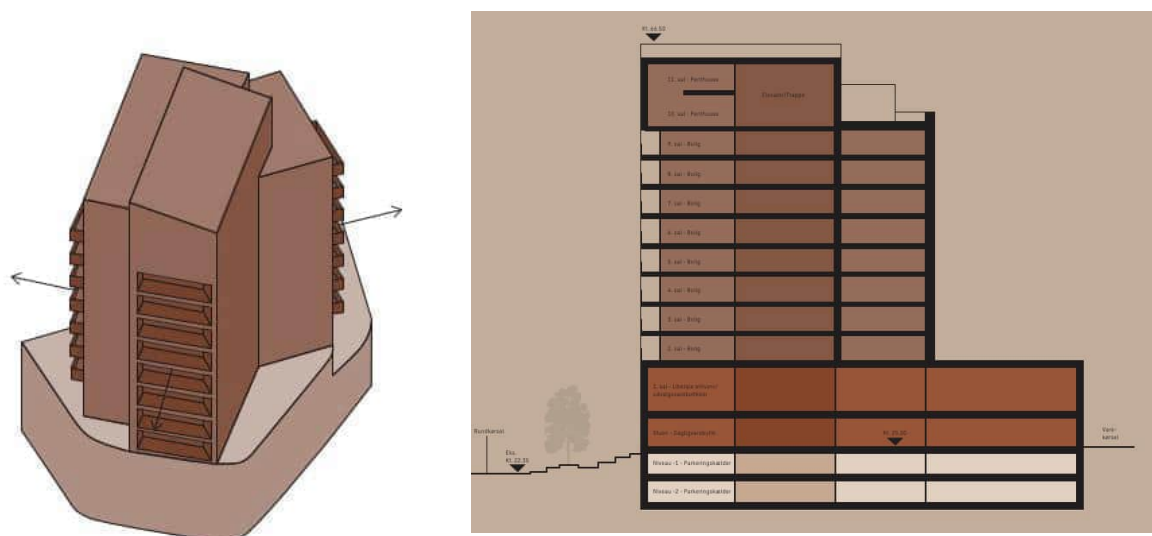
Illustration af foreløbig grundplan/indretningsplan (grundplan markeret med brun).
